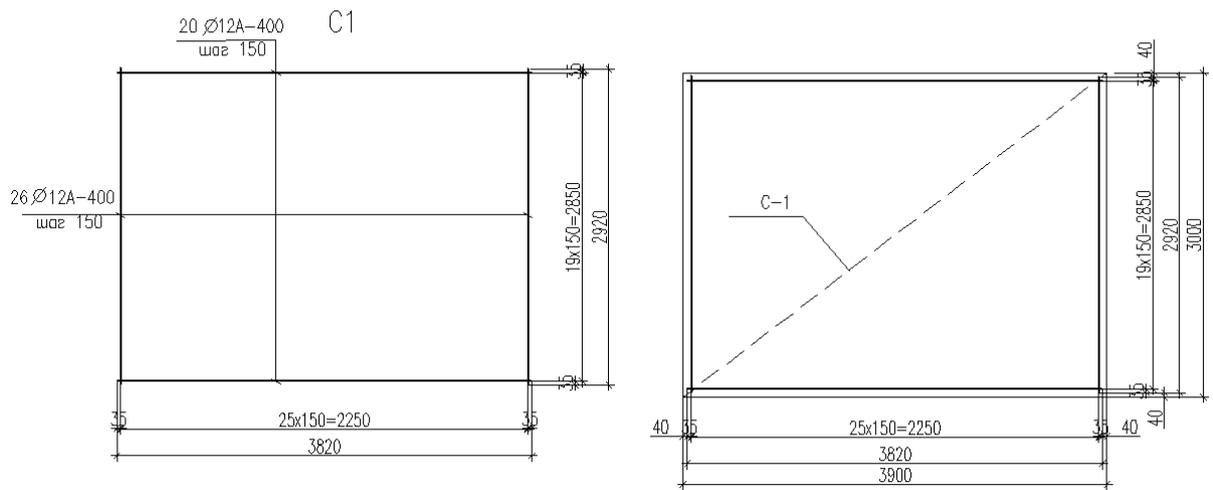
Схема армування підшви фундаменту ФМЗ-1 Арматурна сітка С-1.
